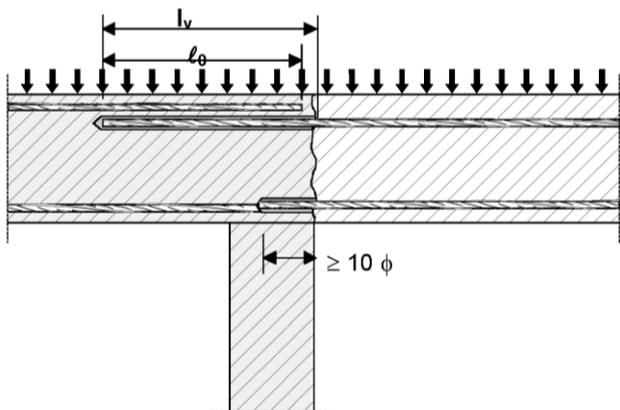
Übergreifungsstoß für Bewehrungsanschlüsse von Platten und Balken
